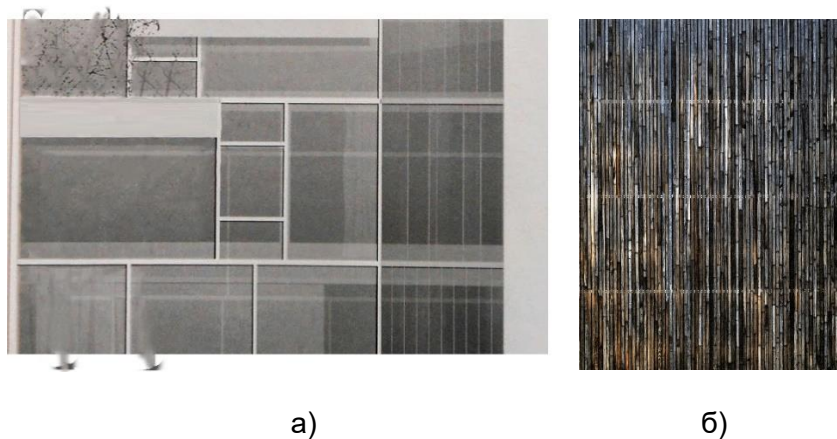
Сравнение фасадных решений объектов: а) Lucerne residential, фрагмент фасада; б) Studio Zumthor, фрагмент фасада
